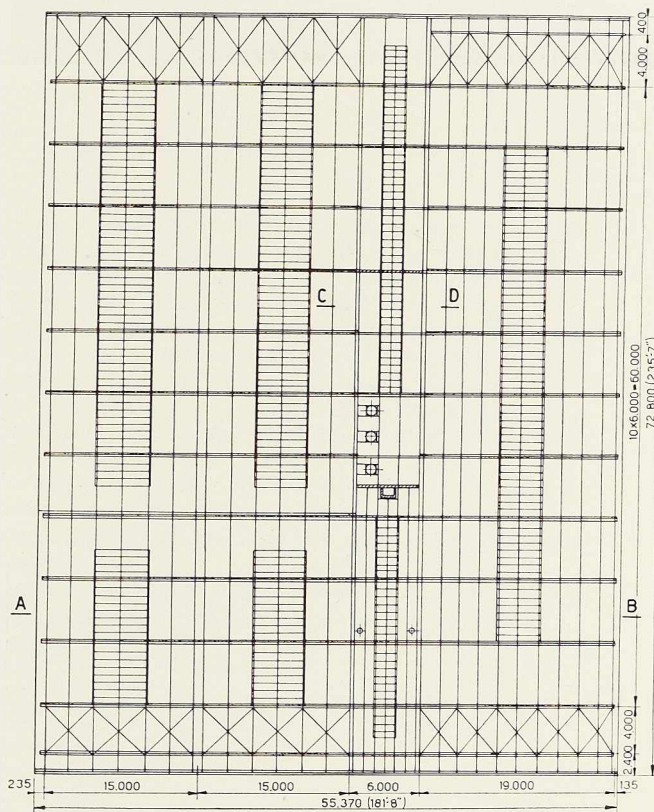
Plan du garage de la figure 9 (voir également fig. 12).
